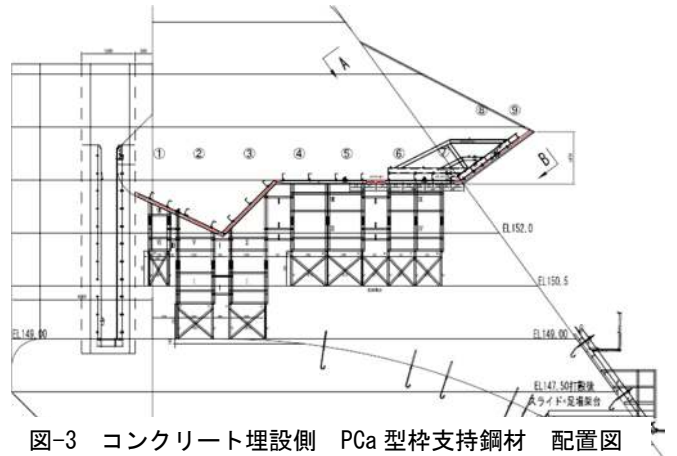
コンクリート埋設側 PCa 型枠支持鋼材 配置図
